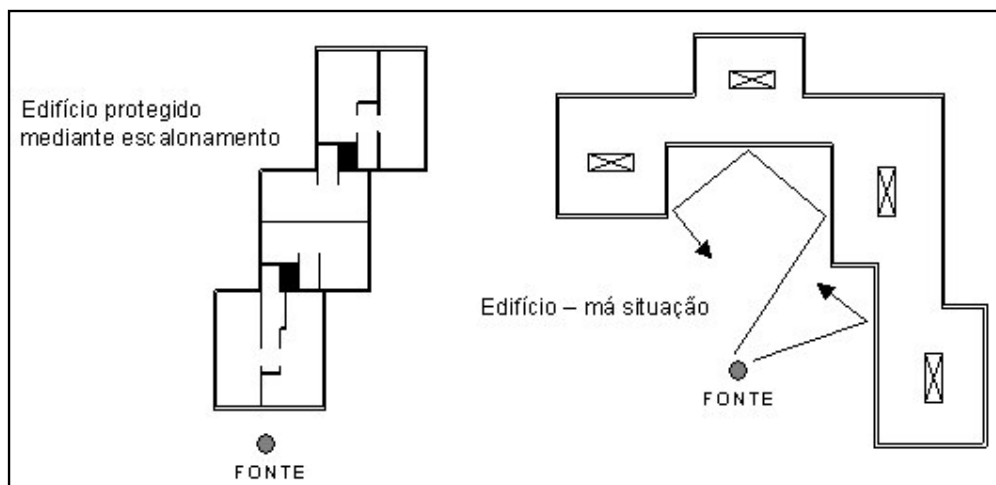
EXEMPLOS DE IMPLANTAÇÃO
